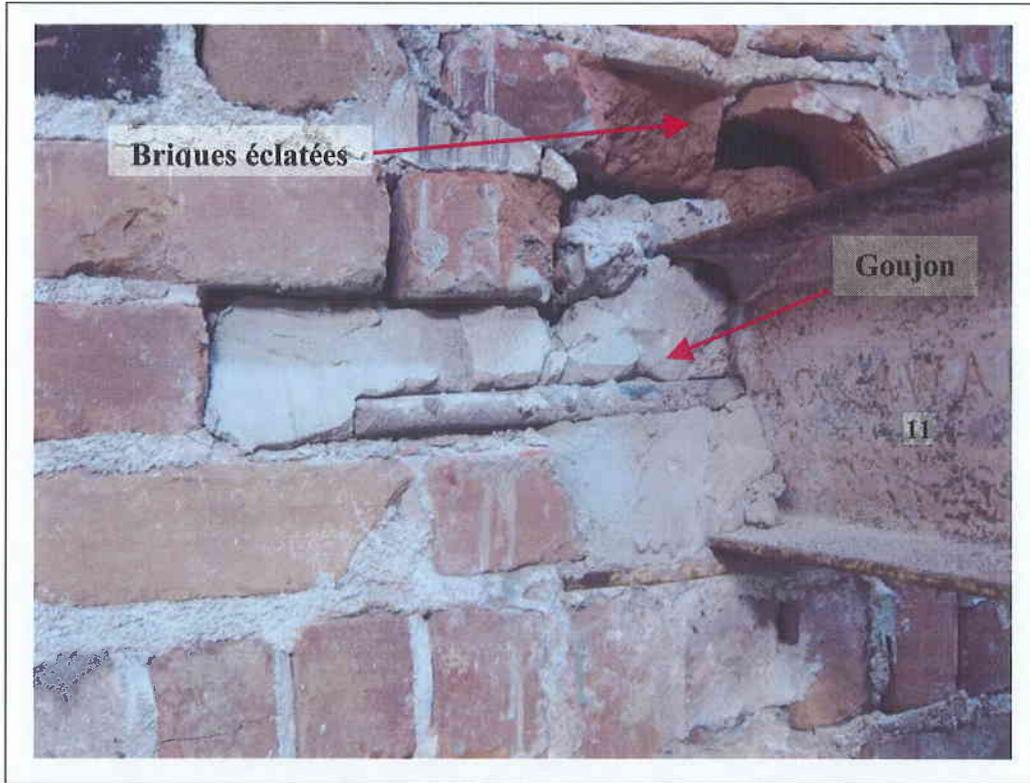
Jonction de la poutre No. 11 avec le mur porteur.
